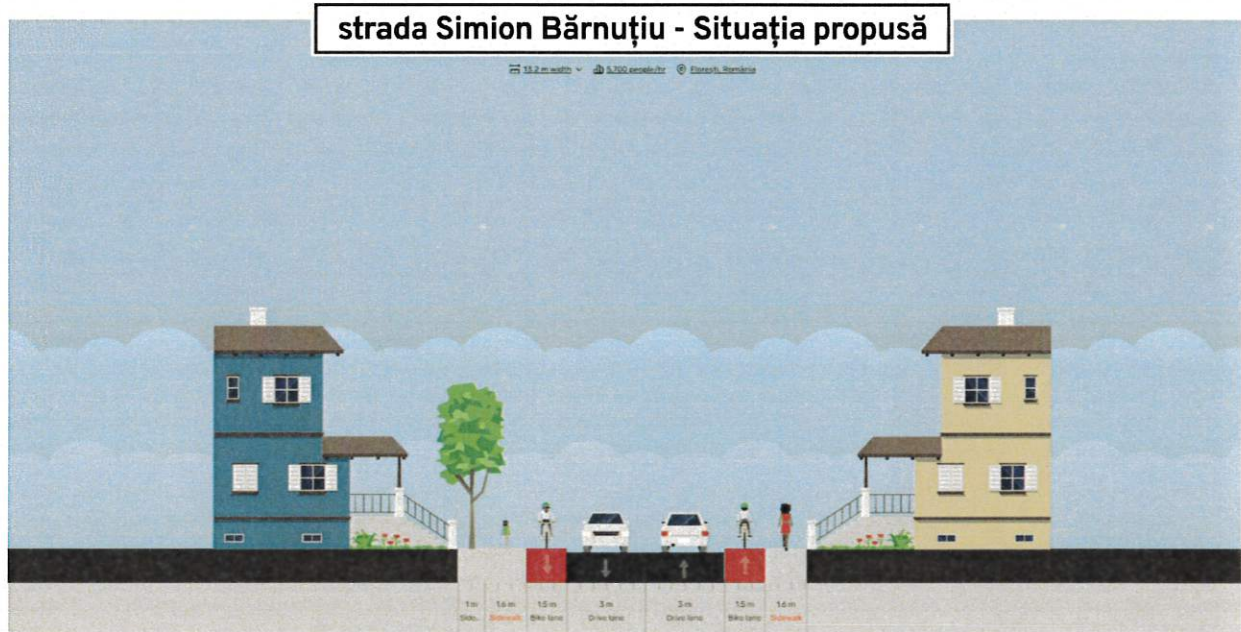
Profil transversal tip - Str. Simion Bărnuțiu situație propusă
